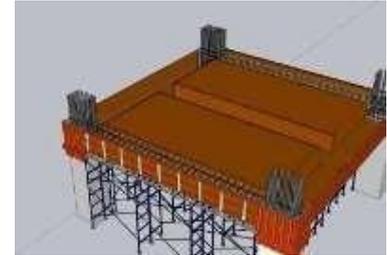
Pemasangan scaffolding dan gelagar plat lantai
